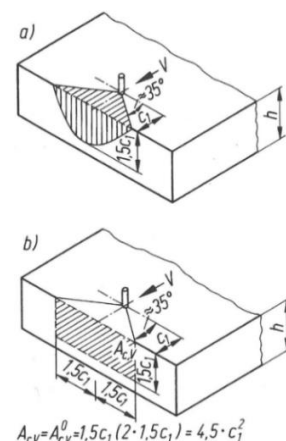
Betonausbruchkörper unter Querlast, Elgehausen/Mallée 2000, 110
